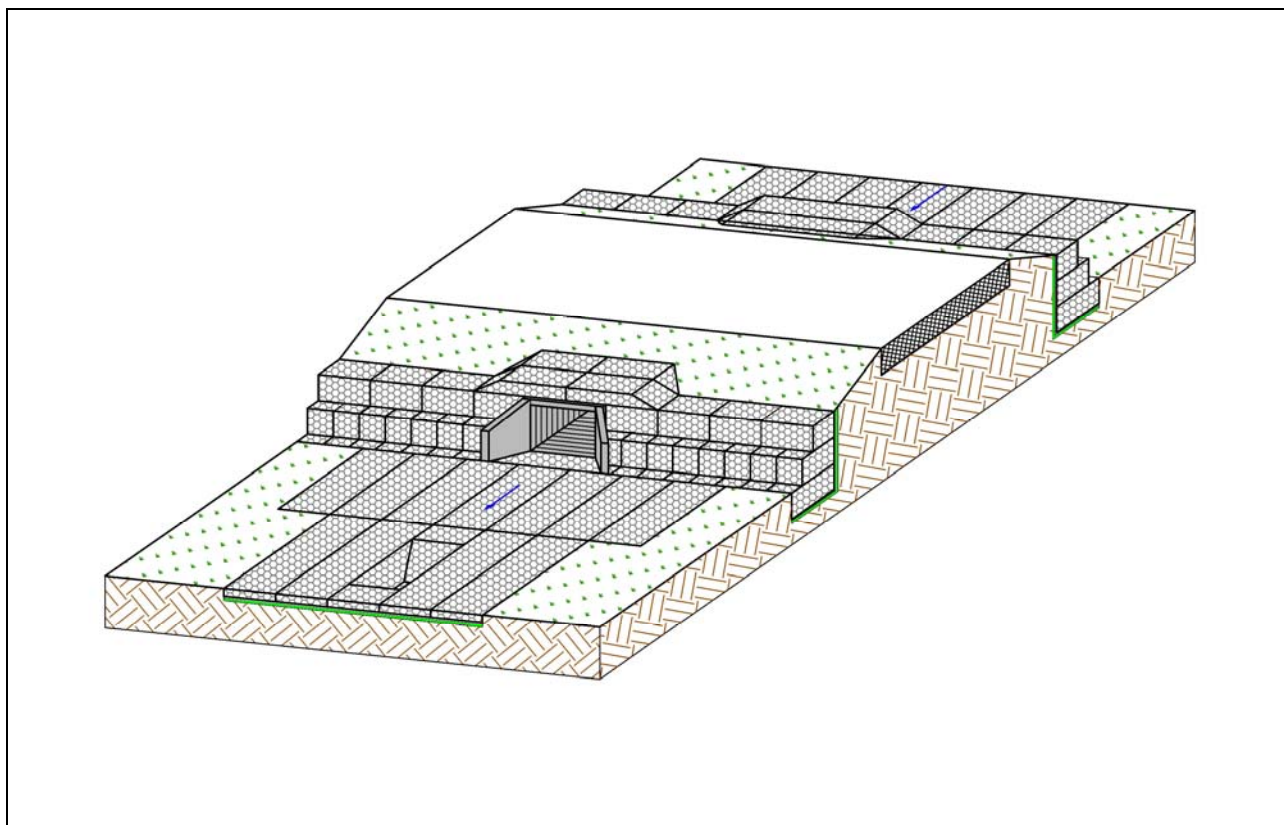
(продолжение) Укрепление оголовков водопропускной трубы и дорожных откосов подпорной стеной из коробчатых габрионных конструкций
